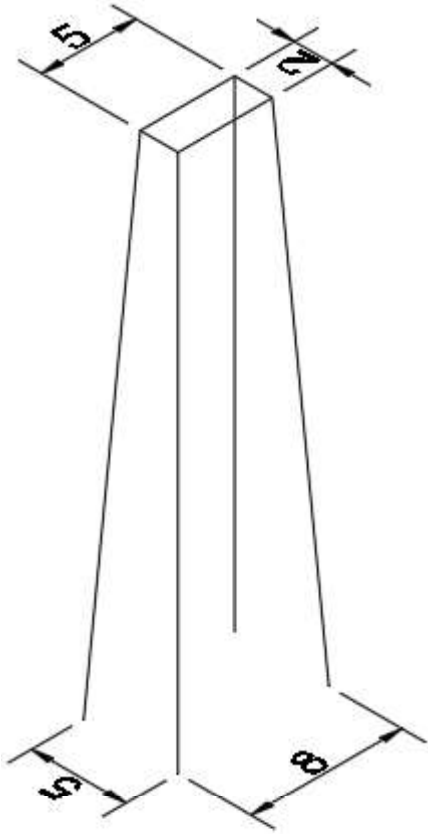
Fase 1 del diseño del fuste del apoyo.
